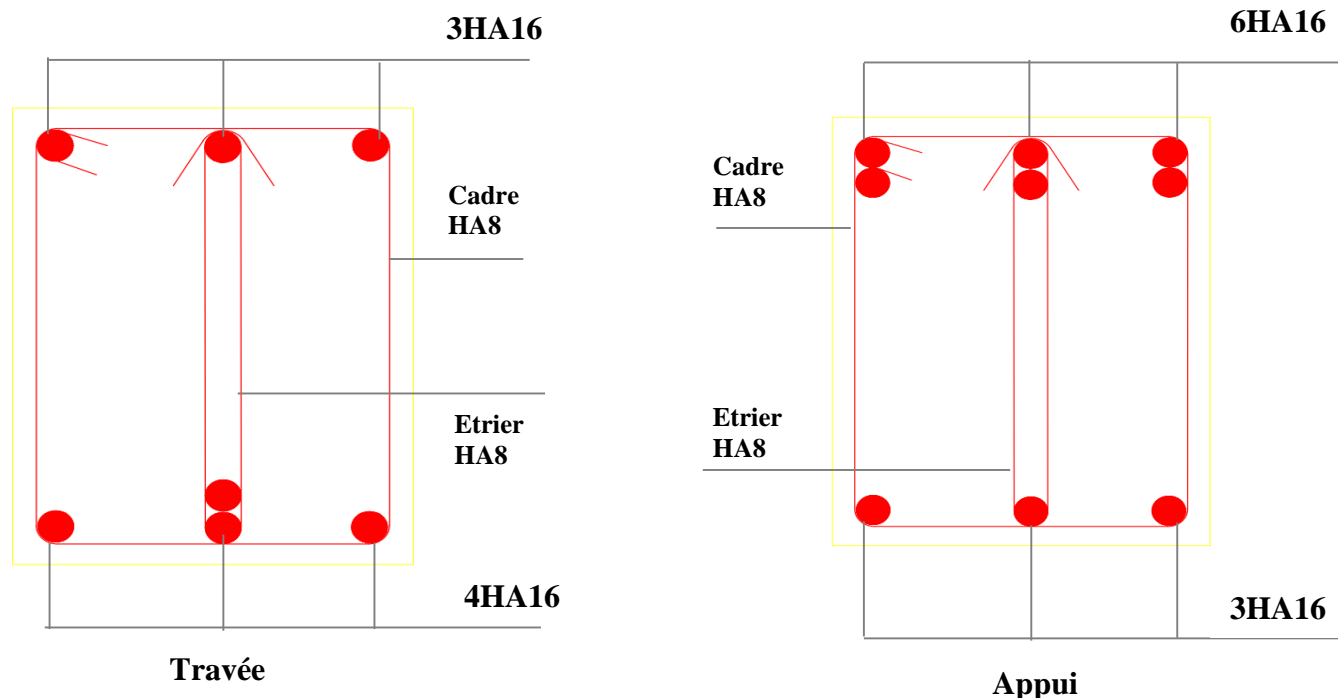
Schéma de ferrailage poutres principales étage 4 jusqu'à étage 10
